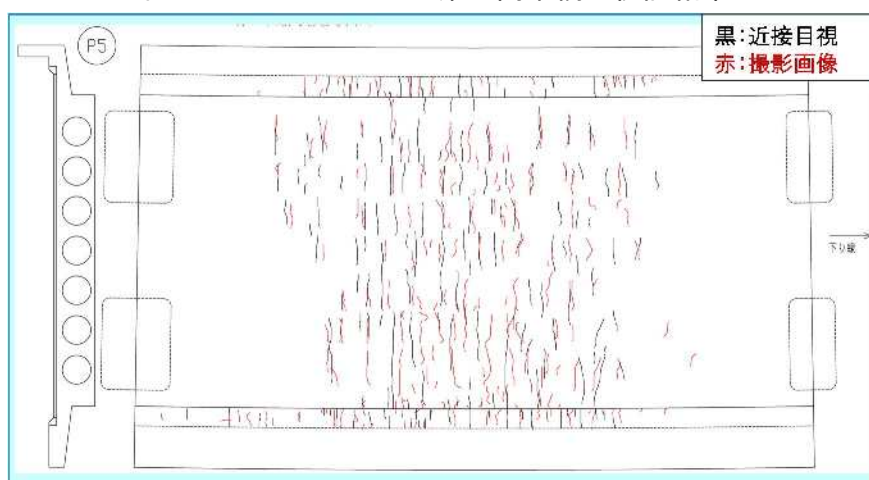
石山第二高架橋 ひび割れ状況比較
